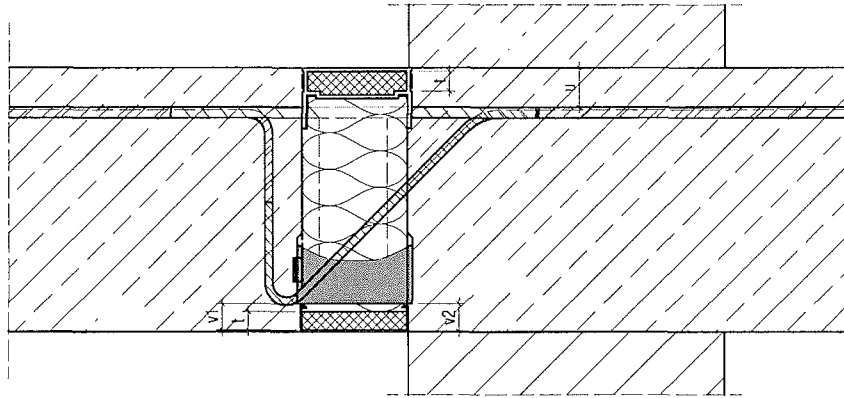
Schöck Isokorb Typ K und Typ KF (F30/F120)
